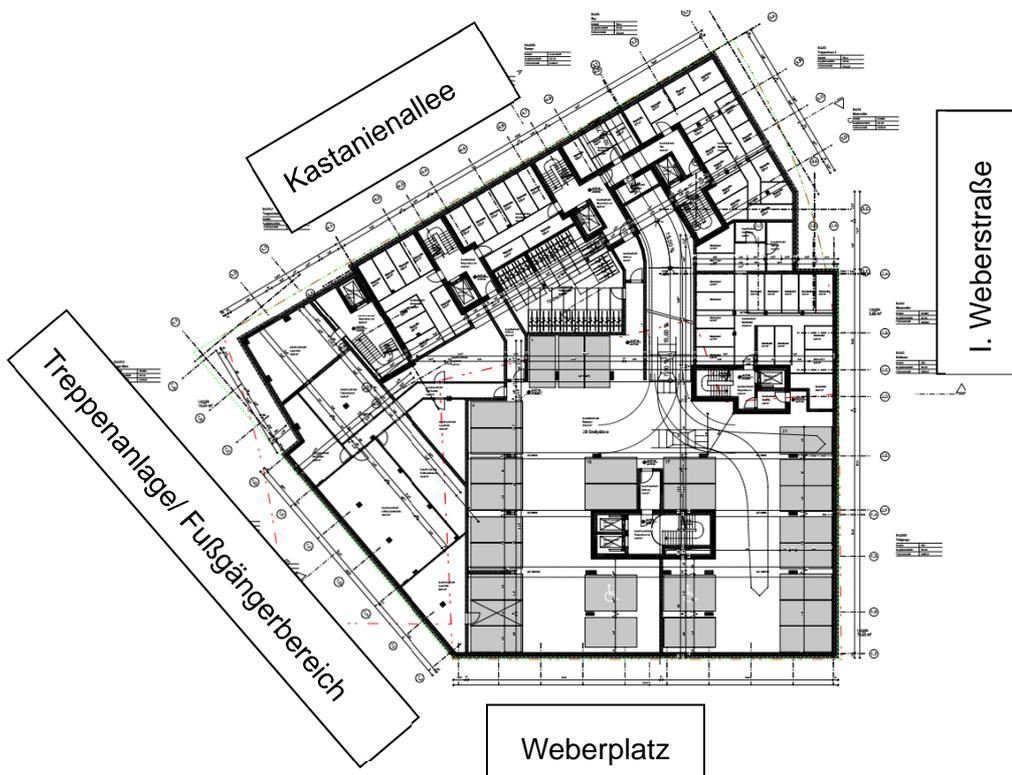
Grundriss Ebene -2, Ausschnitt aus [2]
